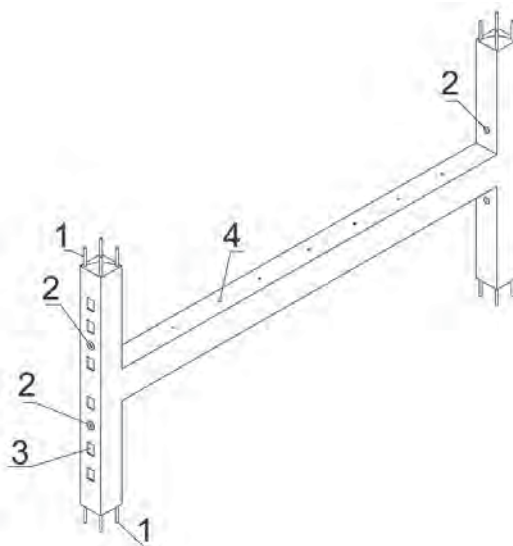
Схема Н-рамы: 1 – выпуск винтовой арматуры; 2 – отверстия в стойках рамы для установки стяжных элементов; 3 – шпонки; 4 – гнезда для забивки нагелей
